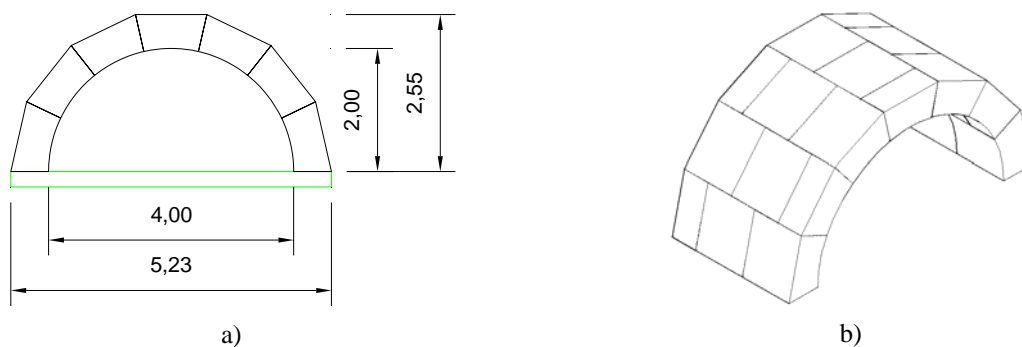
Projecto do protótipo: a) dimensões; b) perspectiva.
